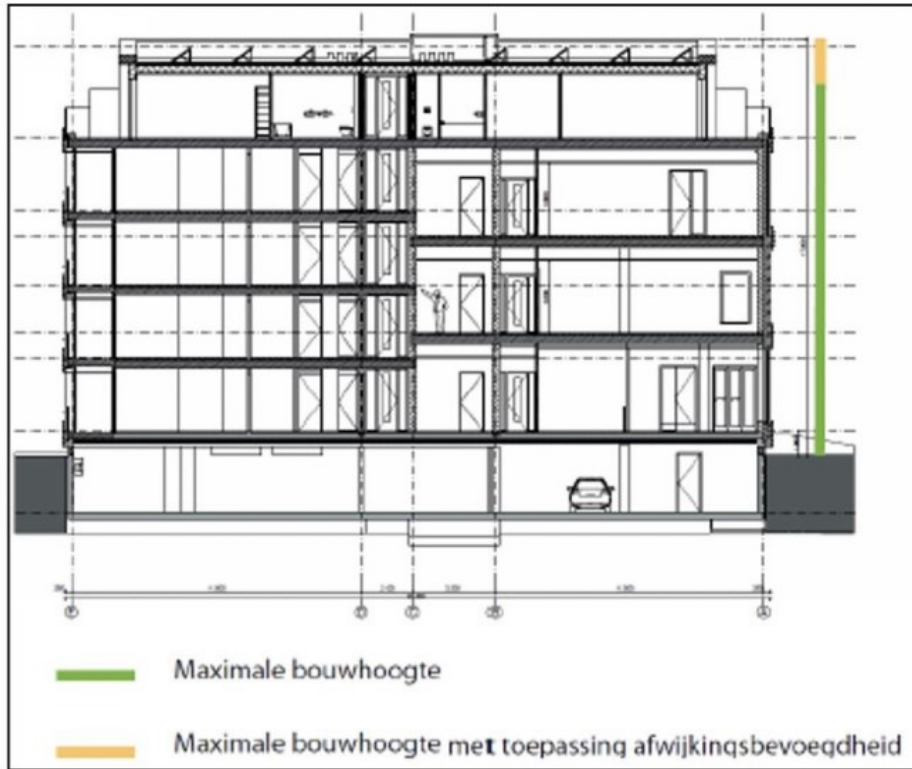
Bouwplan t.o.v. het geldende bouwvlak (Bron: ruimtelijke plannen, bewerkt door BIZ.nu)
